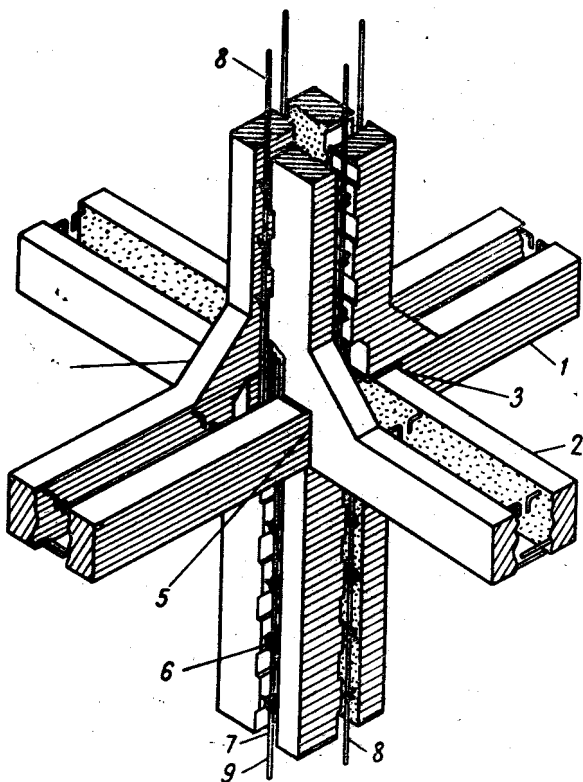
Узел сопряжения элементов каркаса (панели перекрытий условно не показаны)
